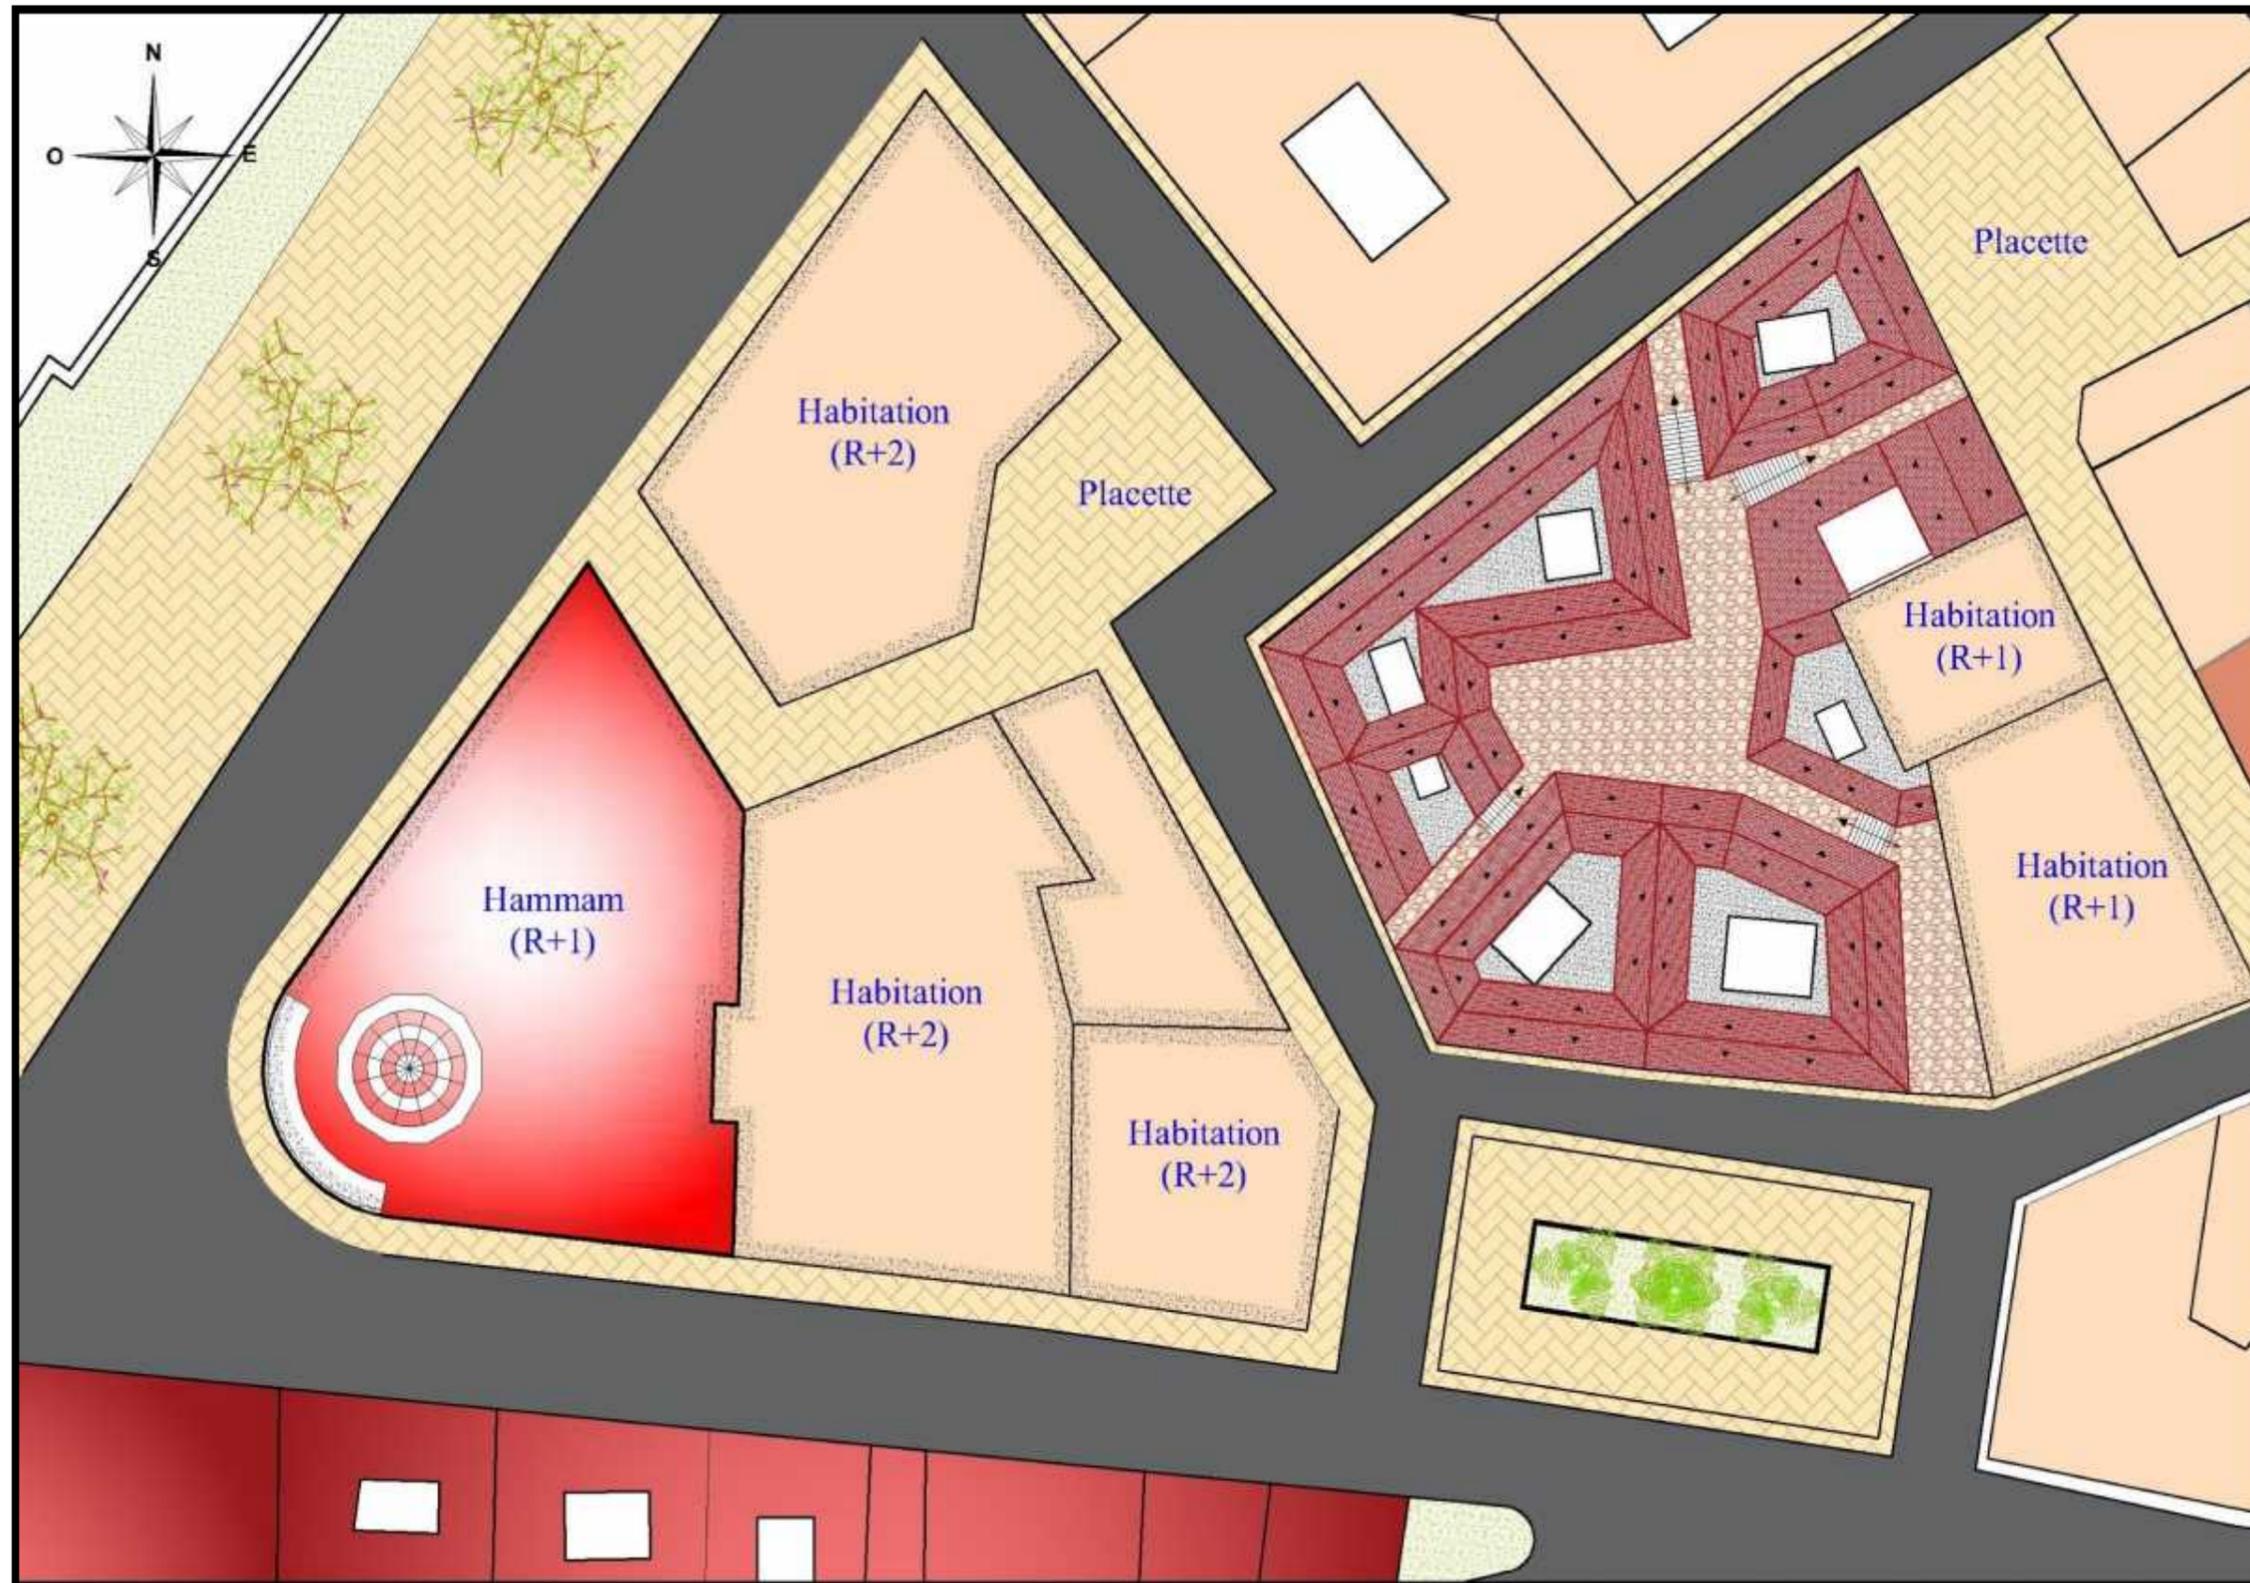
plan de masse –Echelle 1/300-
